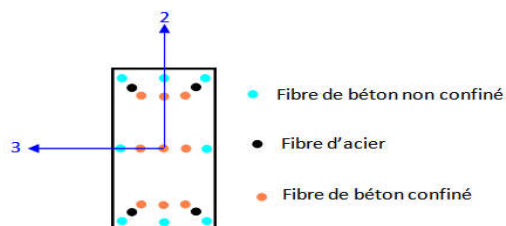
Modèle de fibre de la section transversale de la poutre
